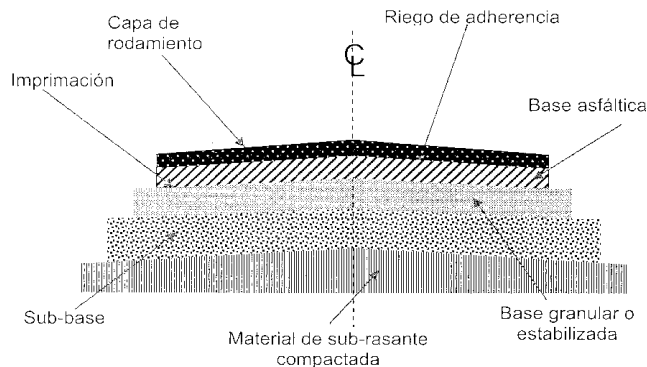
Terminología utilizada corrientemente en ingeniería de pavimentos.
